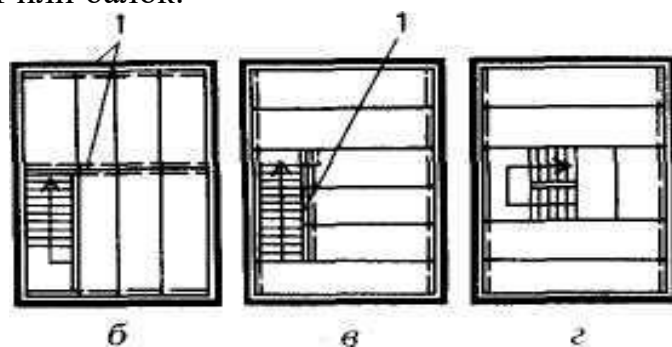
Схемы размещения внутриквартирных лестниц в зависимости от системы укладки и конструкций перекрытий:
